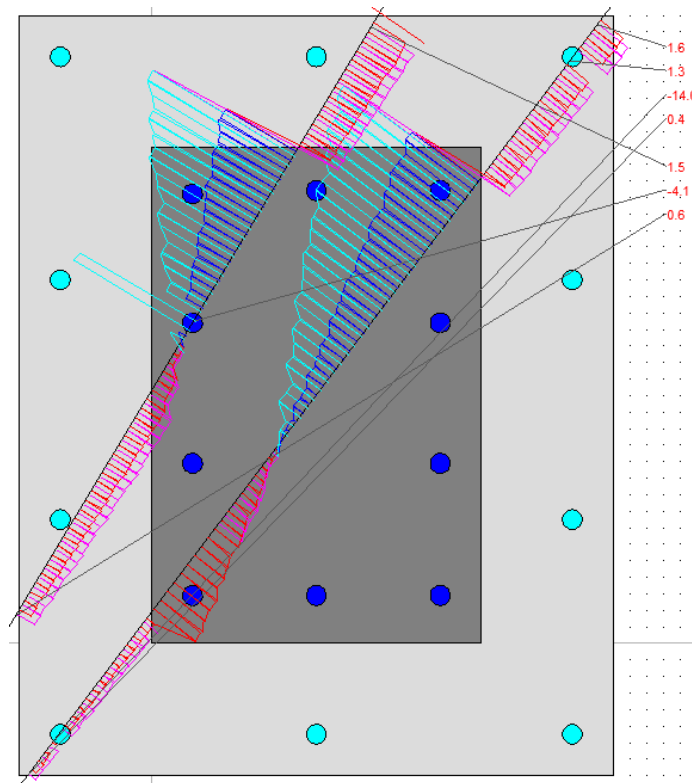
Распределение относительных деформаций и напряжений по поперечному сечению косо сжатой железобетонной колонны, усиленной под нагрузкой железобетонной обоймой, при действии усадки
